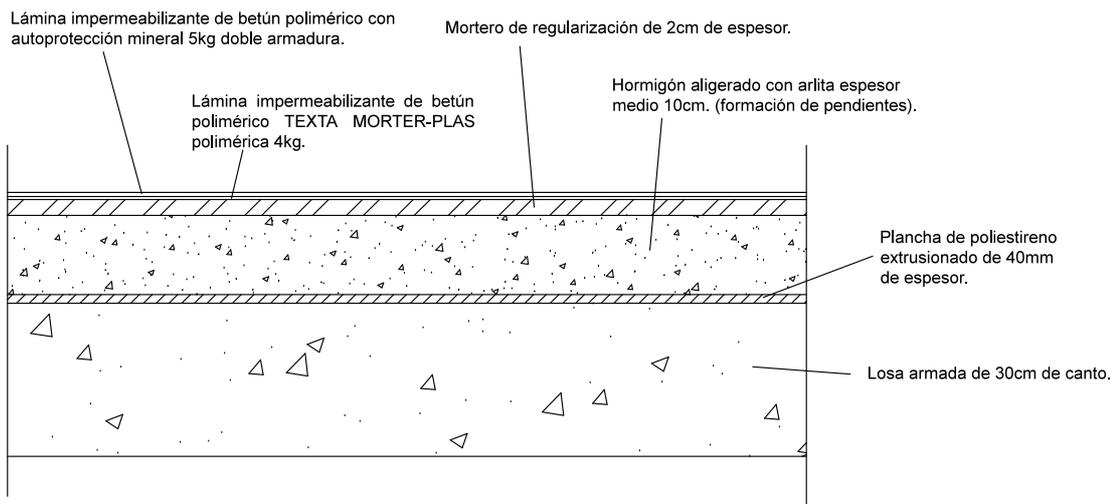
Detalle constructivo cubierta plana no transitable con acabado de lámina autoprotegida (acceso, casetón escalera y ascensor).
